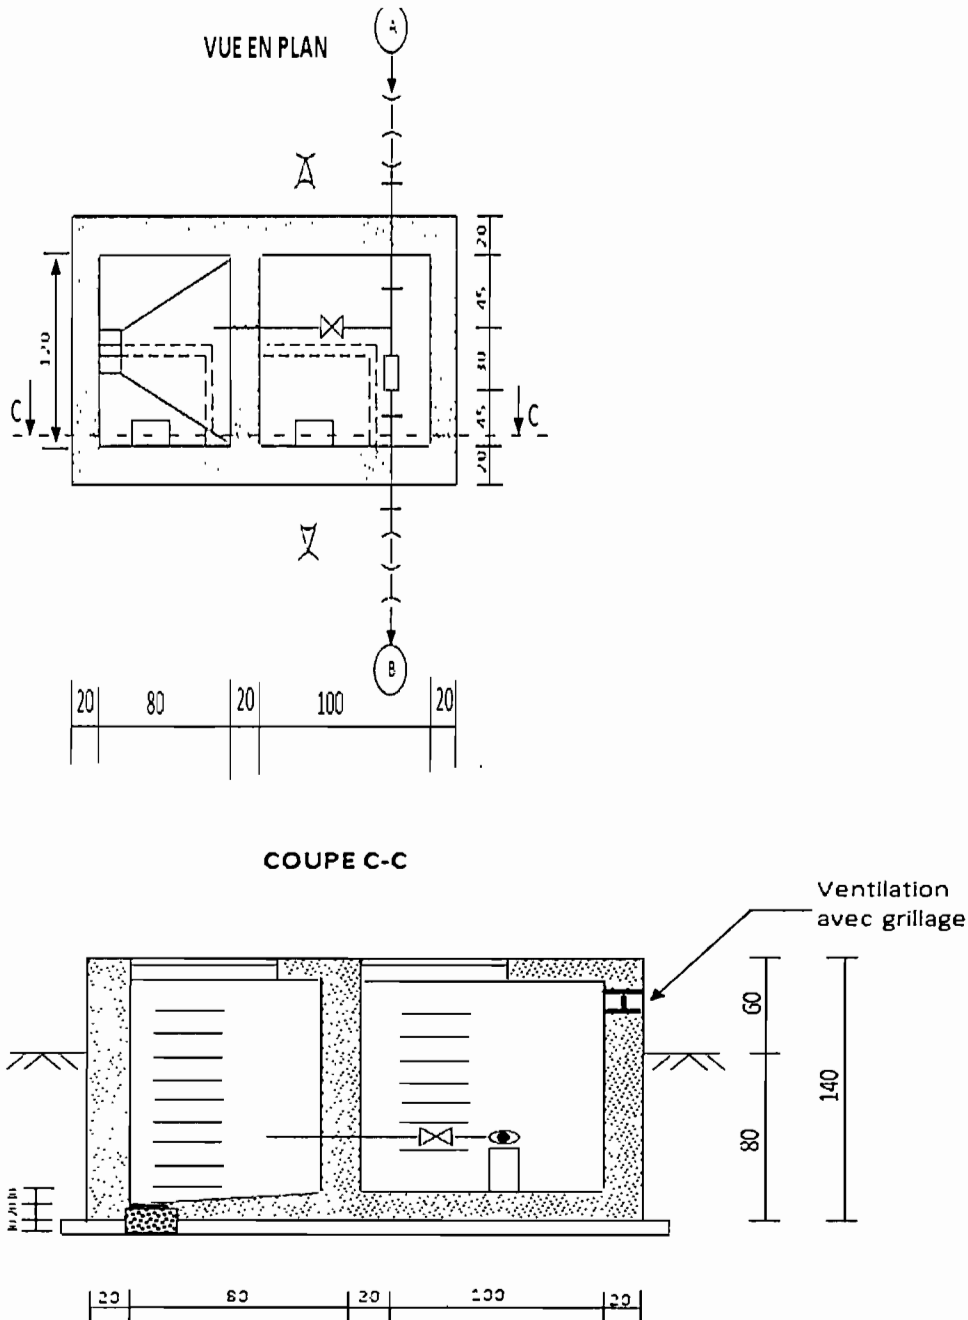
Schéma de vue en plan et coupe d'une chambre de purge
